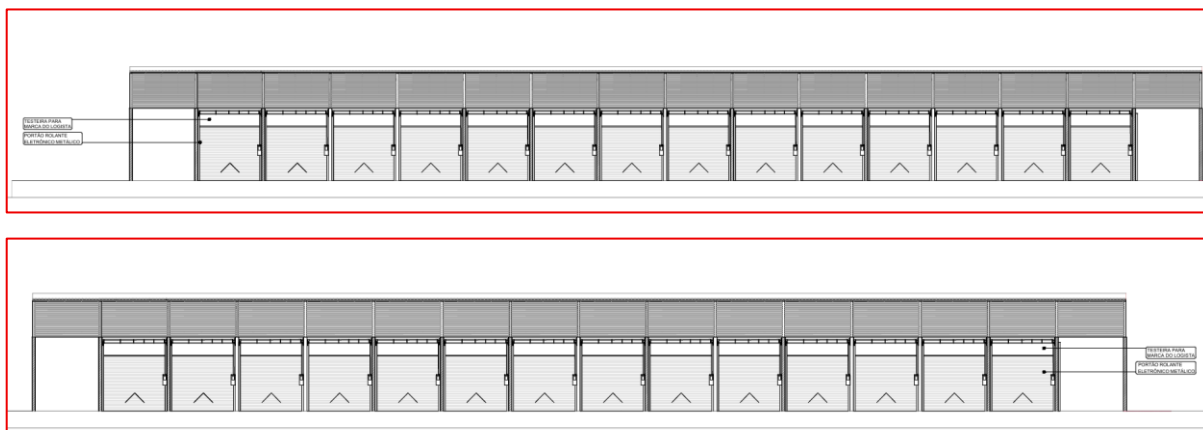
Elevação Frontal e Posterior. Fonte: Projeto.
